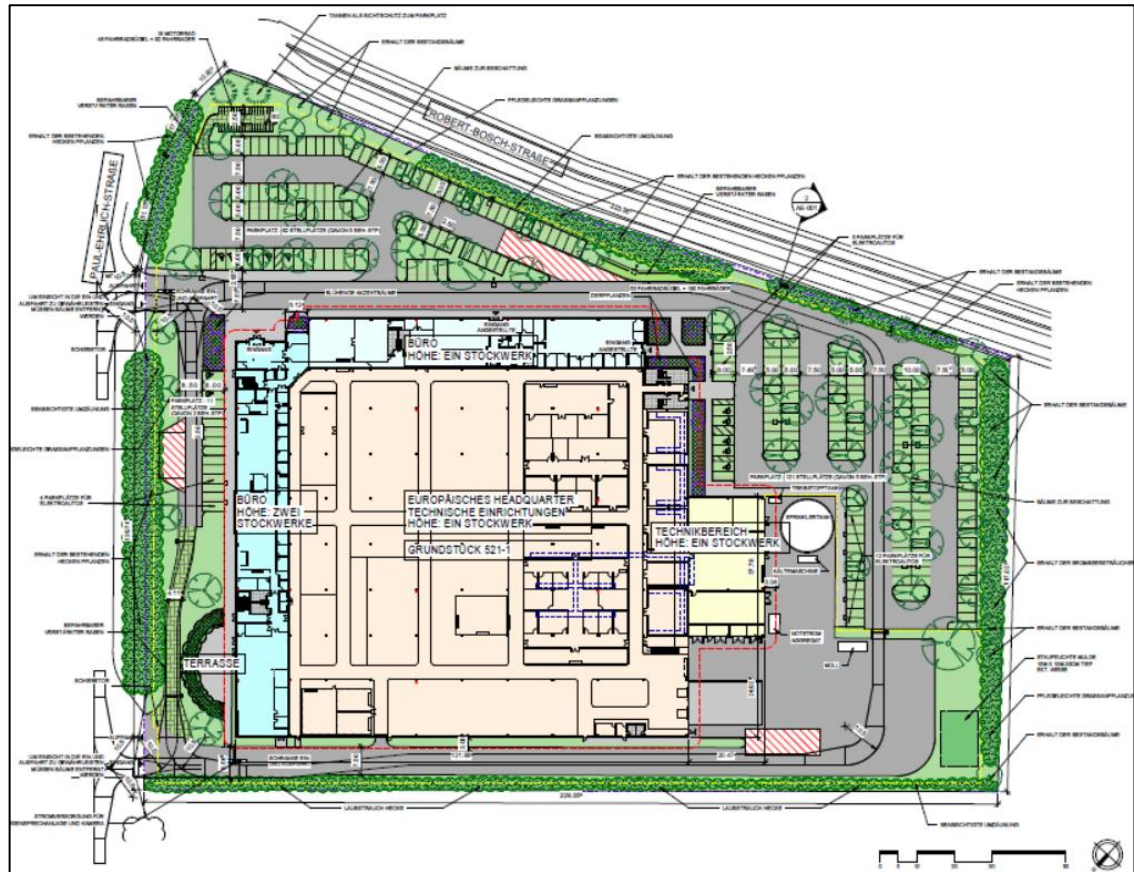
Lageplan / Vorhaben- und Erschließungsplan (Quelle: SSOE Group / Scalaplan GmbH, Stand 17.06.2019)
